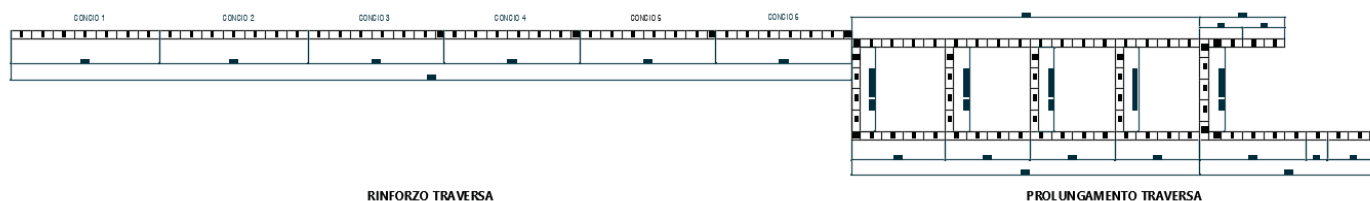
Planimetria delle diaframature come realizzate (Libretto misure SAL 10)
